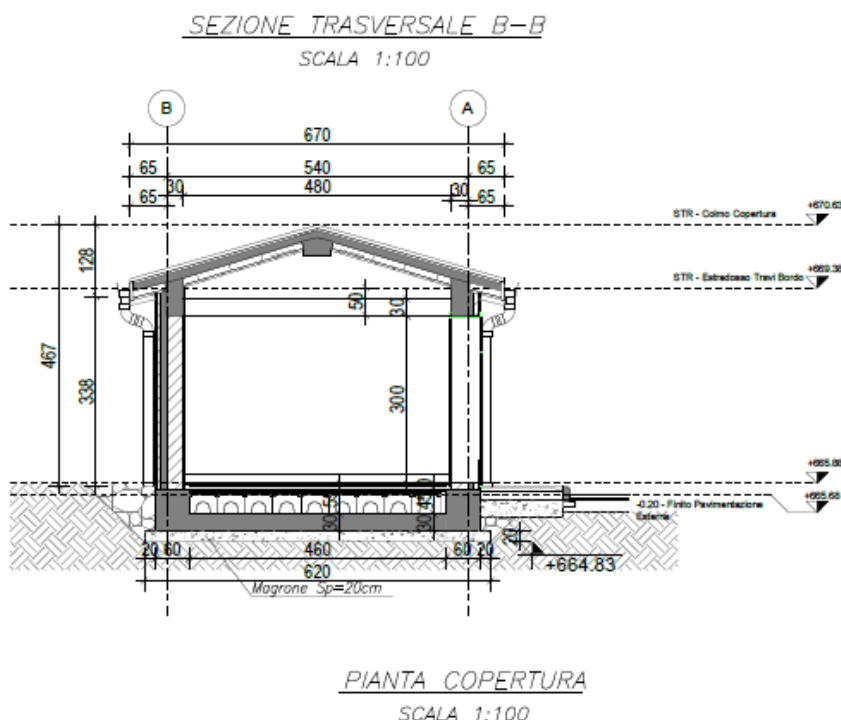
Planimetria uffici – sezione Trasversale - scala 1:100
